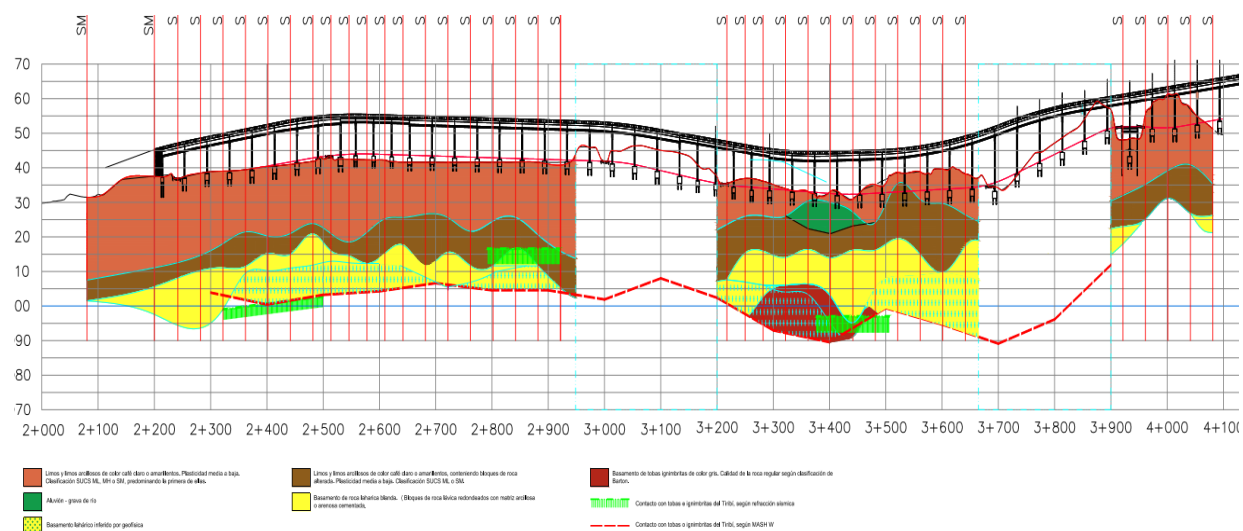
Ubicación de pruebas según perfil geotécnico longitudinal del proyecto.
